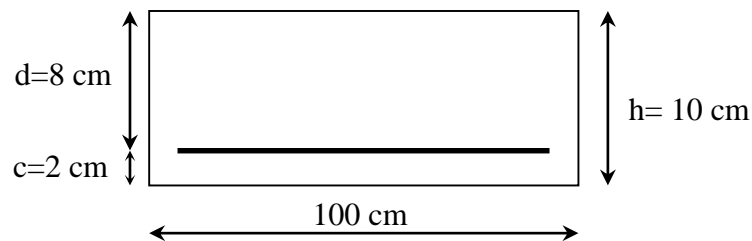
Dimensions de la section de calcul du ferrailage de l'acrotère
